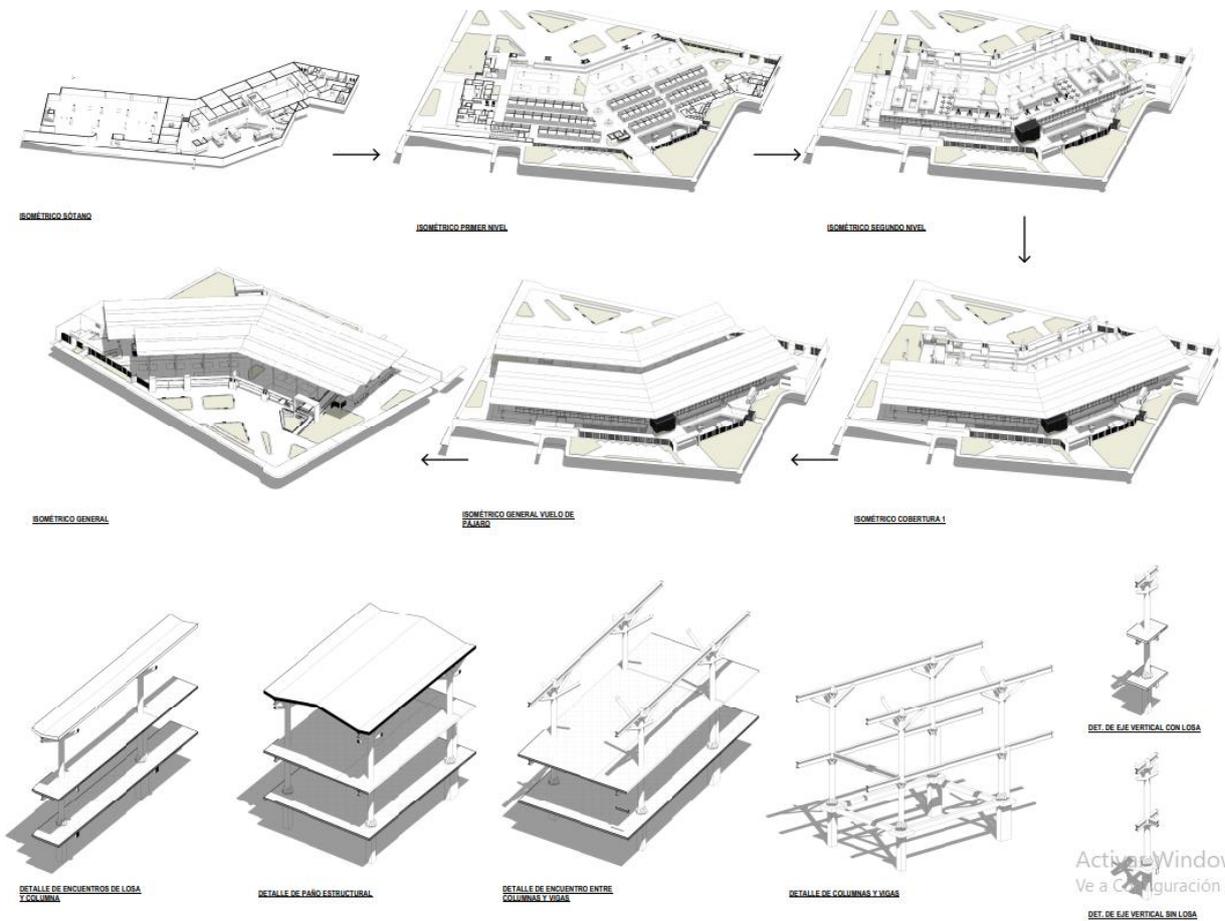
Detalles de Cobertura y anclajes (Ver lamina A-14)
